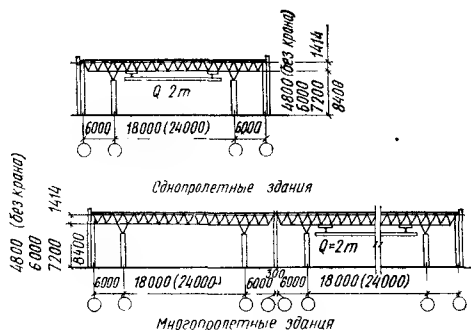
Габаритные схемы зданий с покрытием «Модуль»
